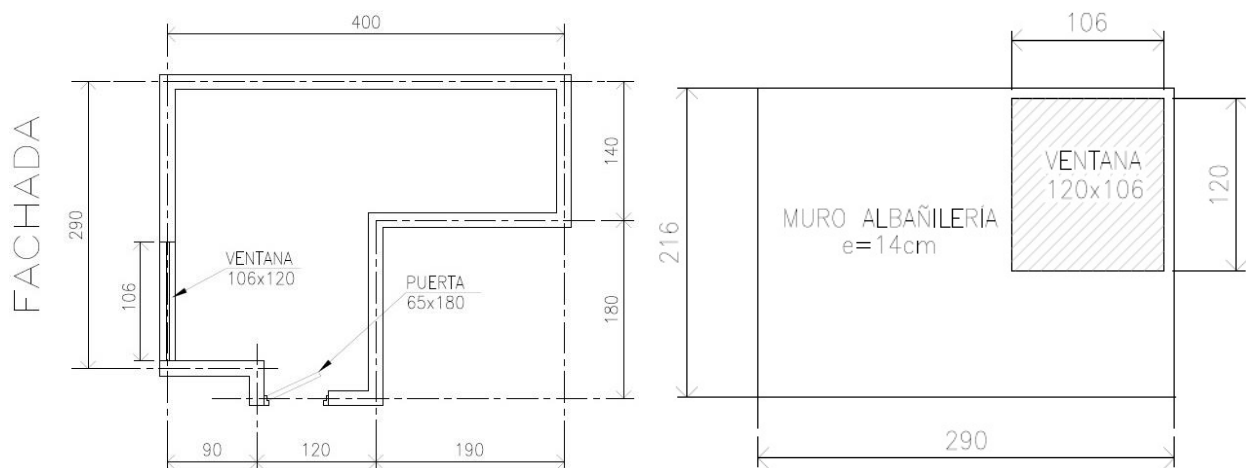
Vista en planta y elevación del recinto utilizado para el ensayo.
